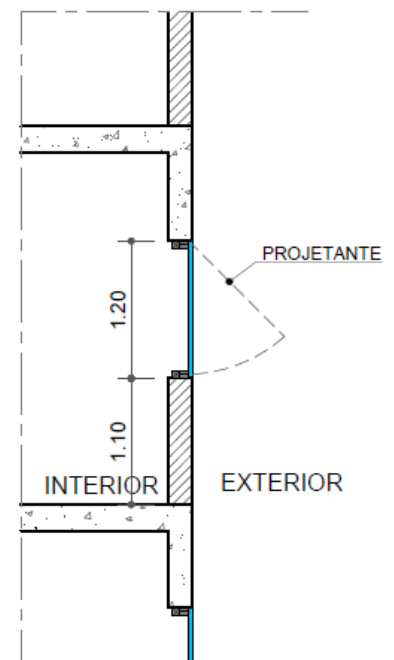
Seção das aberturas de todas as fachadas do edifício de estudo
